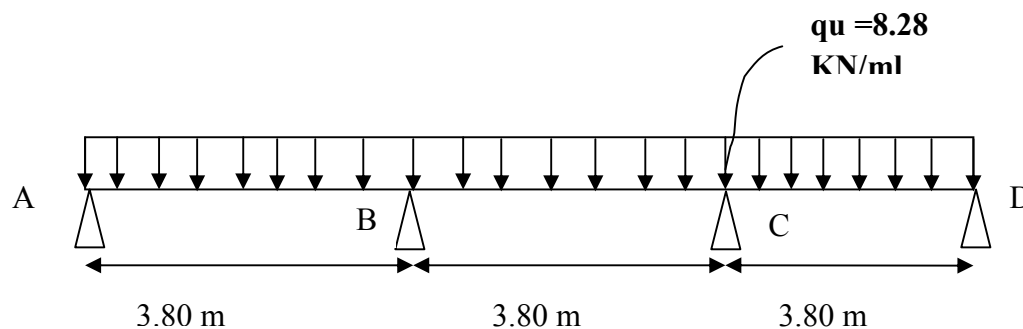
Schéma statique de la poutre continue reposant sur quatre appuis
